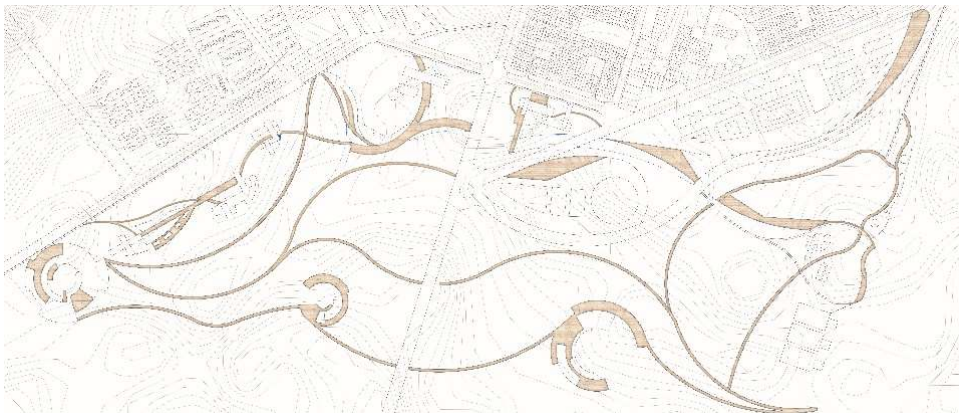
Estructura vial del Plan Parcial M.A.N.G.O.
